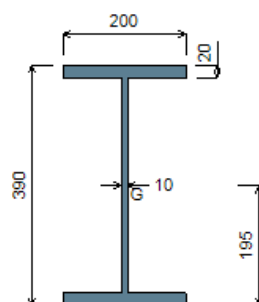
Section transversale de PRS étudié (dimensions en mm)
